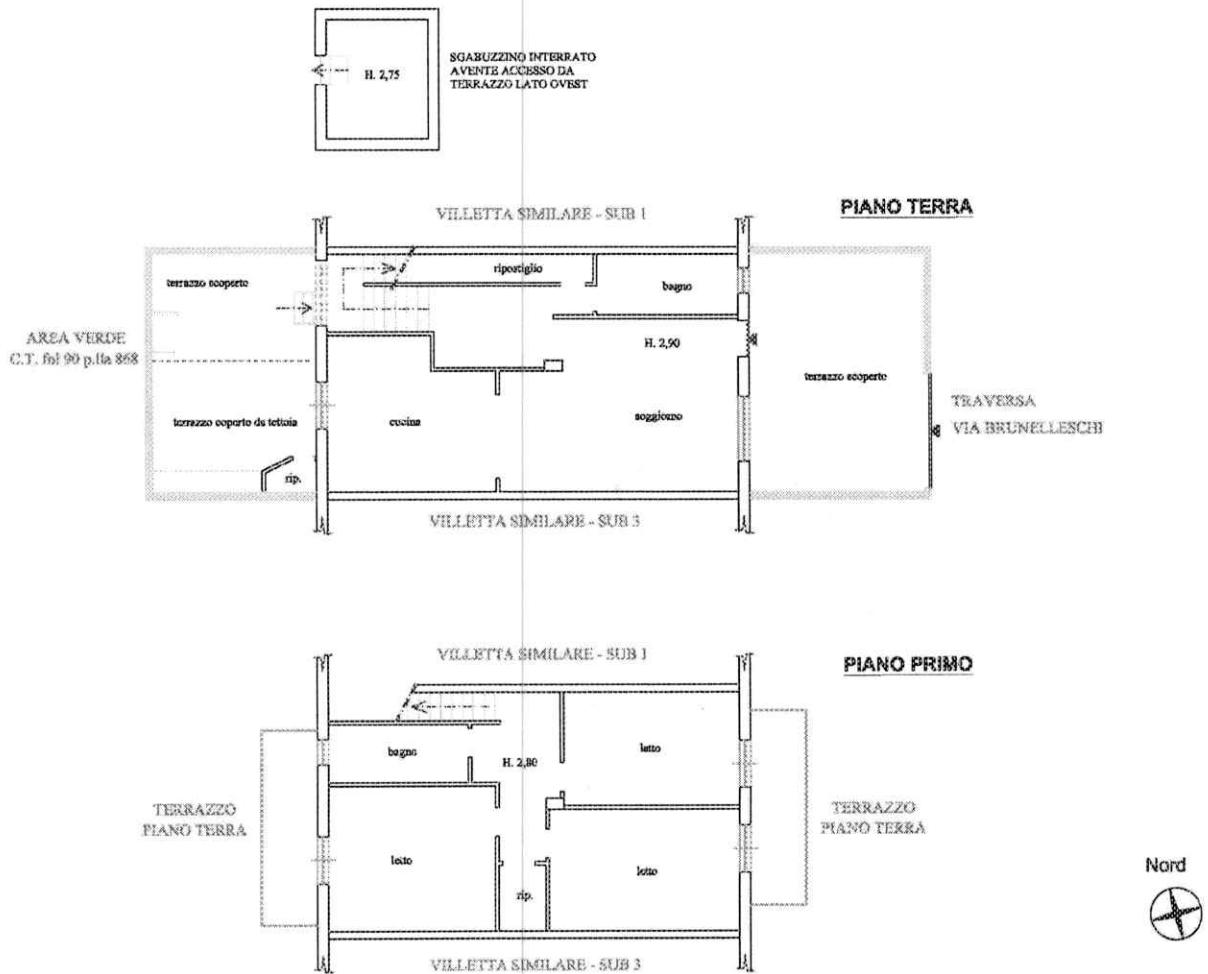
Planimetria attuale dell'immobile pignorato (fuori scala)
